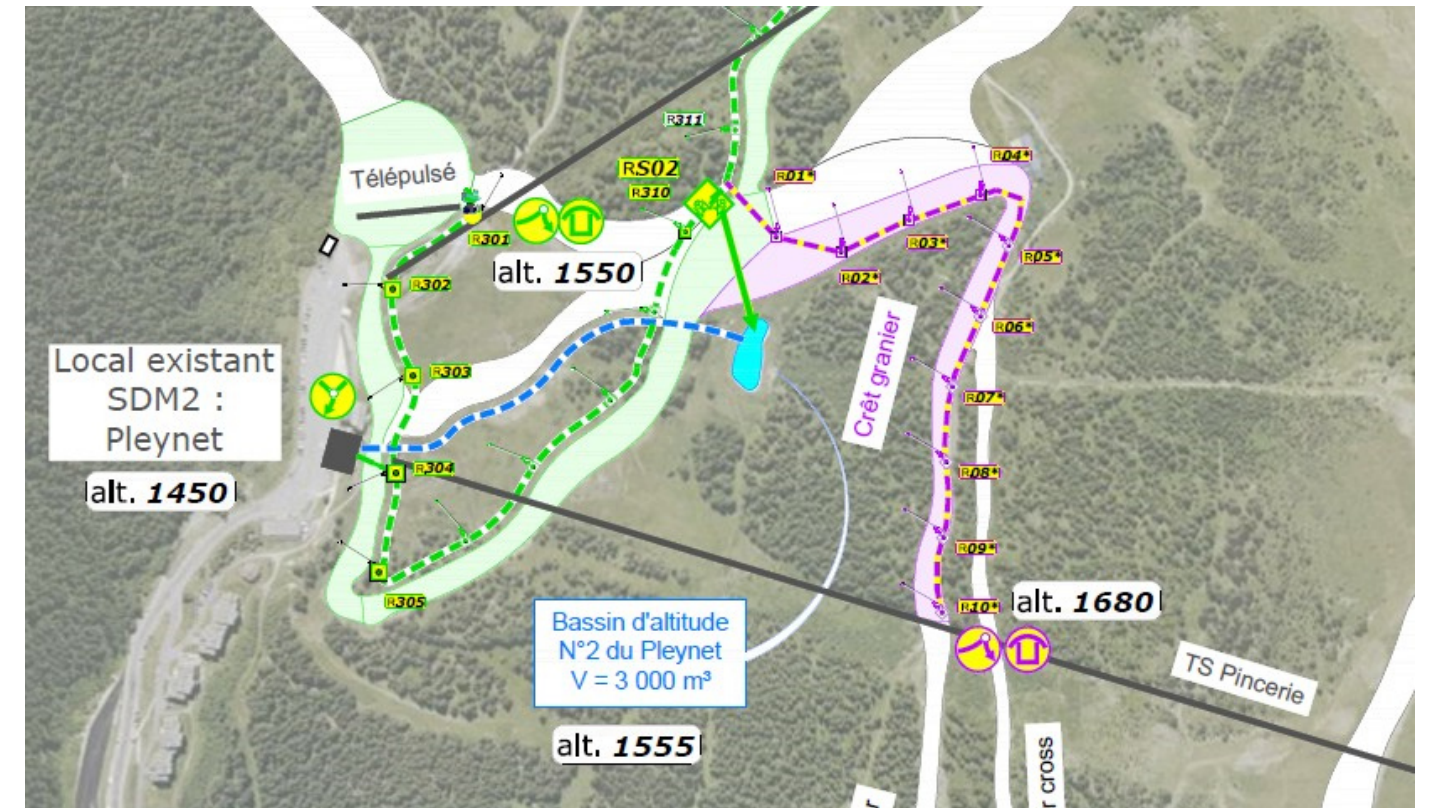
Vue aérienne du projet d'enneigement de la piste de Crêt Granier (en violet sur le plan)
